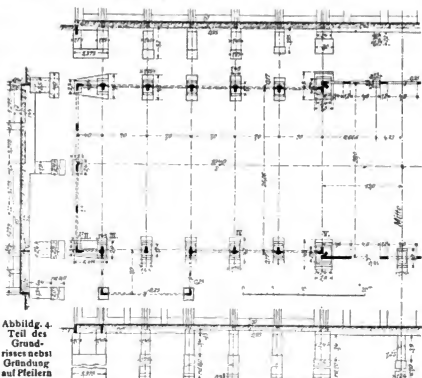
Teil des Grundrisses nebst Gründung auf Pfeilern
